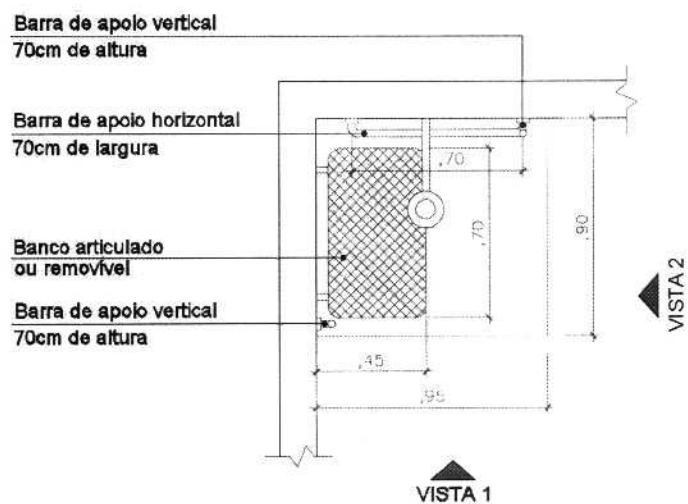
Planta baixa - detalhe de instalação da boxe acessível
